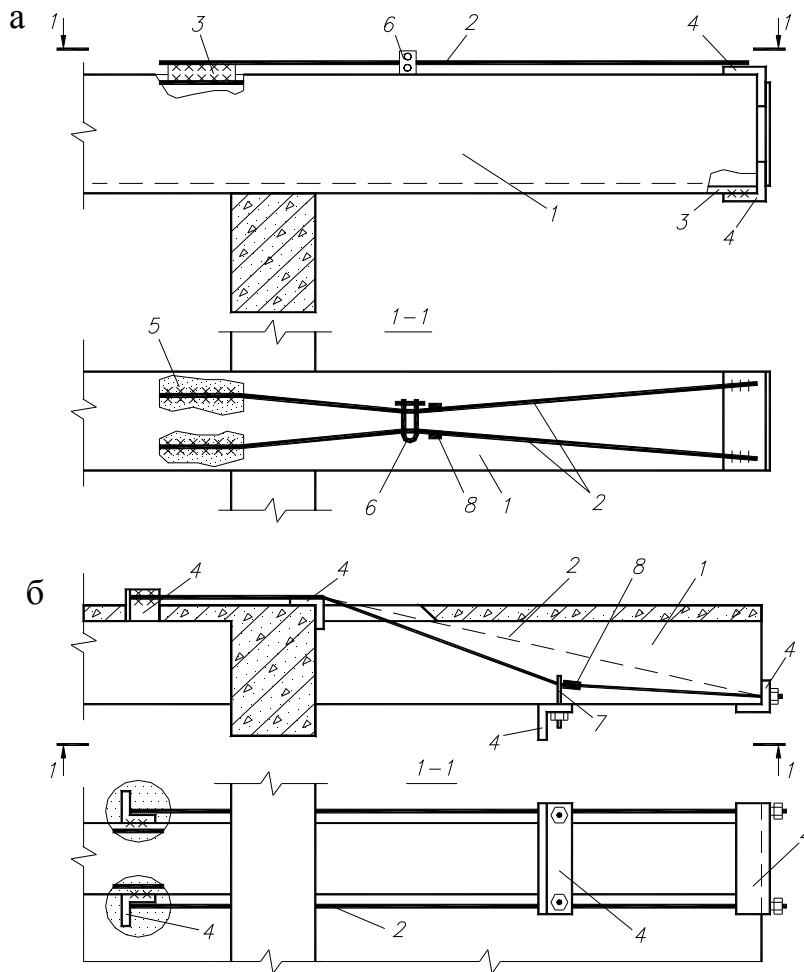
Усиление длинных консолей затяжками: *а* – горизонтальной; *б* – диагональной, 1 – усиливаемая конструкция, 2 – затяжка, 3 – пластина, 4 – уголок, 5 – сварной шов, 6 – стяжной болт, 7 – натяжной болт, 8 – упор
